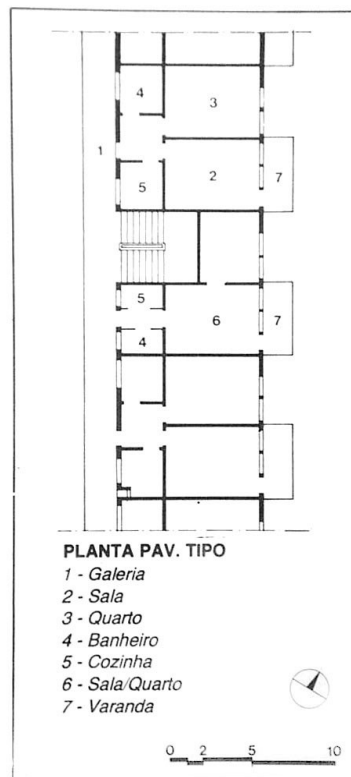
Planta pavimento tipo com apartamentos de 1 dormitório.
